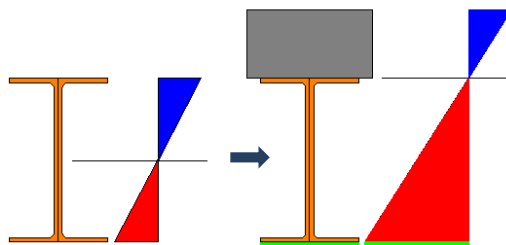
Distribución tensional en la sección transversal de un sistema híbrido.
